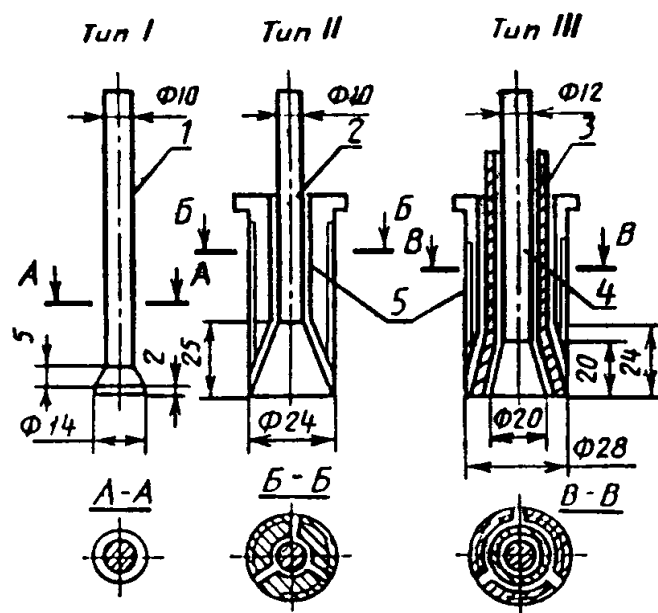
Типы анкерных устройств: 1 - рабочий стержень; 2 - рабочий стержень с разжимным конусом; 3 - рабочий стержень с полым разжимным конусом; 4 - опорный стержень; 5 - сегментные рифленые щеки
